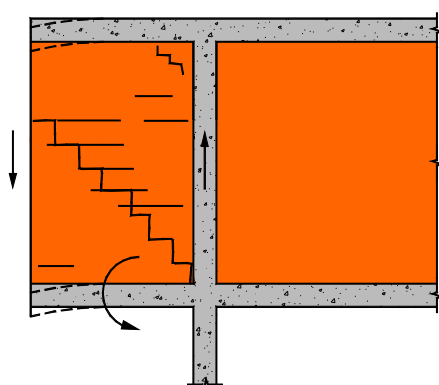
Fissuras na alvenaria, provocadas por deformação da viga na região do balanço [30]
